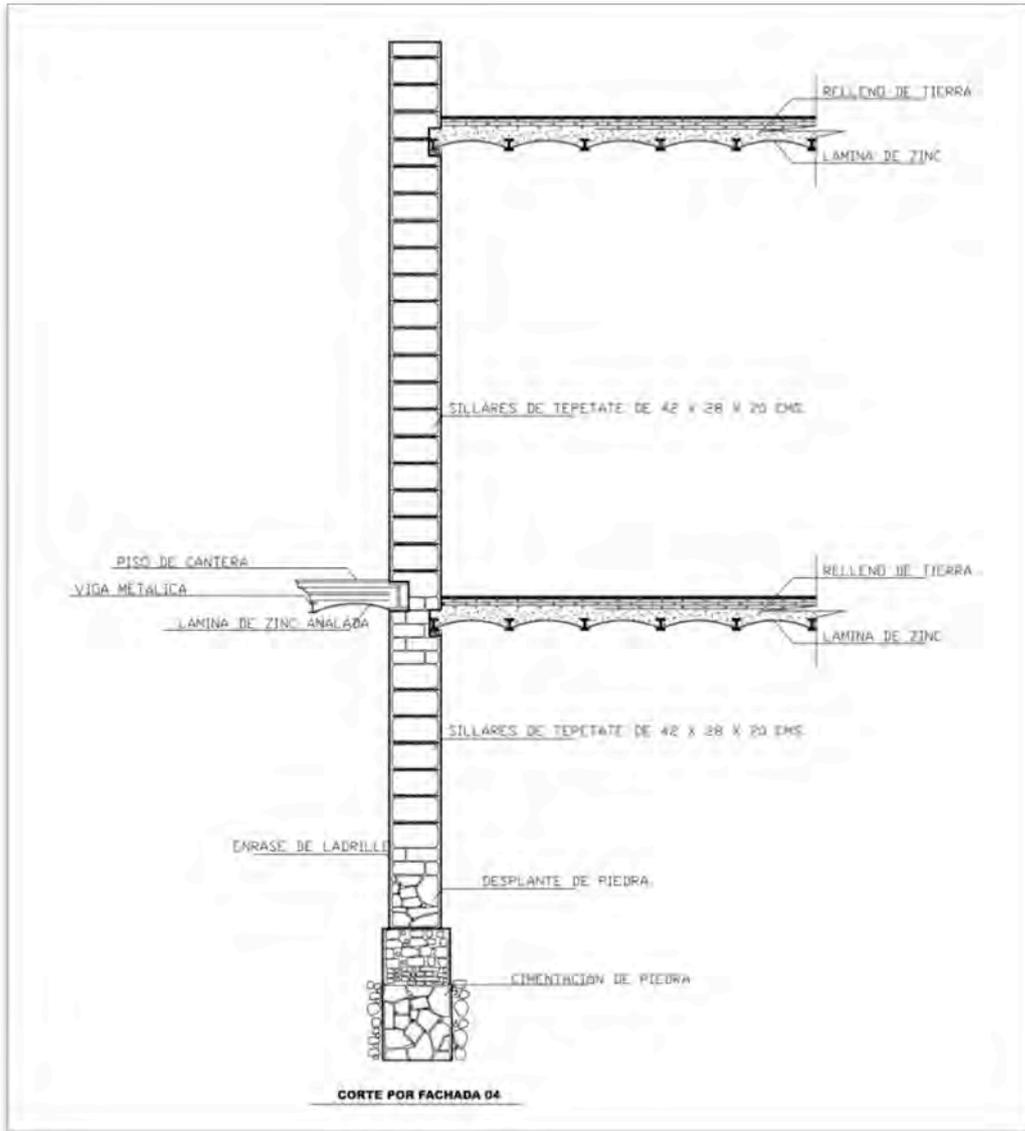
Corte por fachada que muestra el sistema constructivo de los muros del Palacio de Autonomía,
